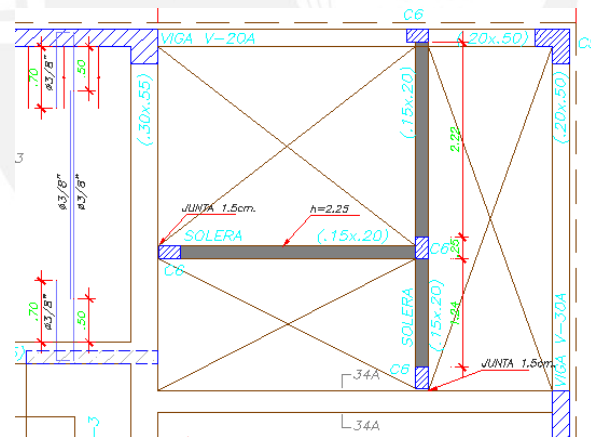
Albañilería – Ubicación de Columnas de Amarre.
